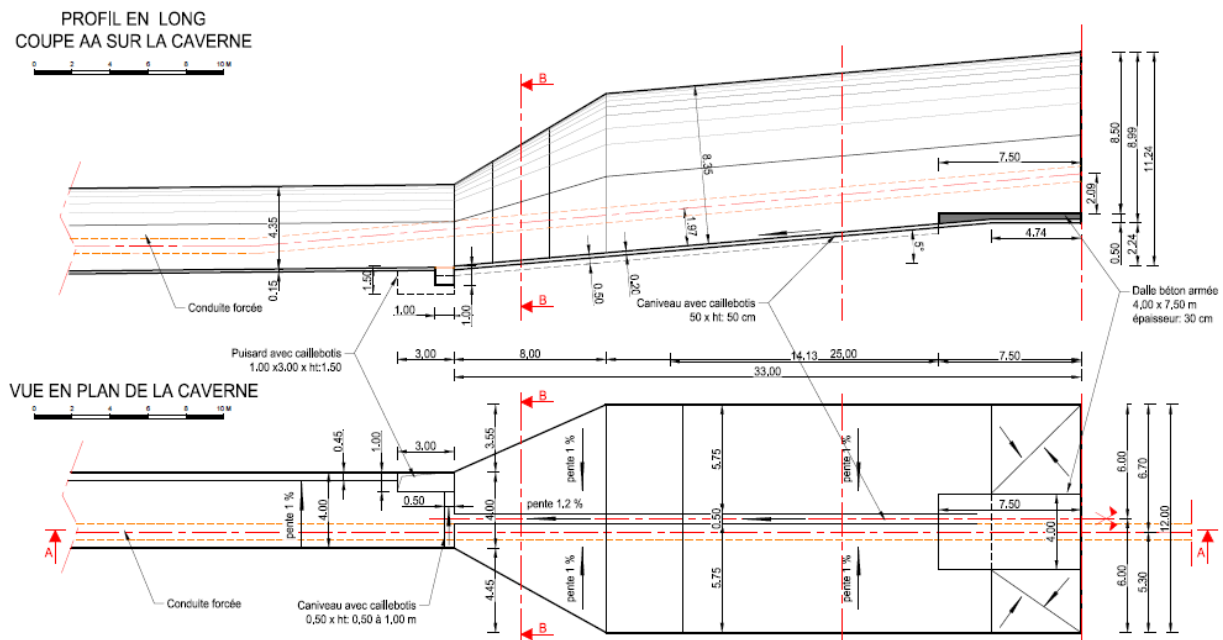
Profil en long et vue en plan de la caverne en fond de galerie
